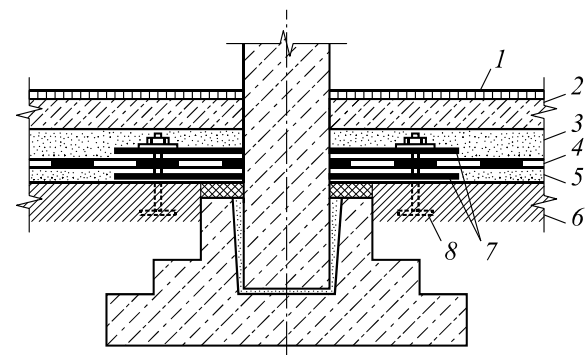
Конструкция гидроизоляции около отдельного фундамента под железобетонную колонну: 1 – покрытие пола; 2 – конструкция пола подвала; 3 – защитная цементная стяжка, 20 мм; 4 – рулонная гидроизоляция; 5 – выравнивающая цементная стяжка, 30 мм; 6 – бетонная подготовка; 7 – стальной лист; 8 – анкерный болт
